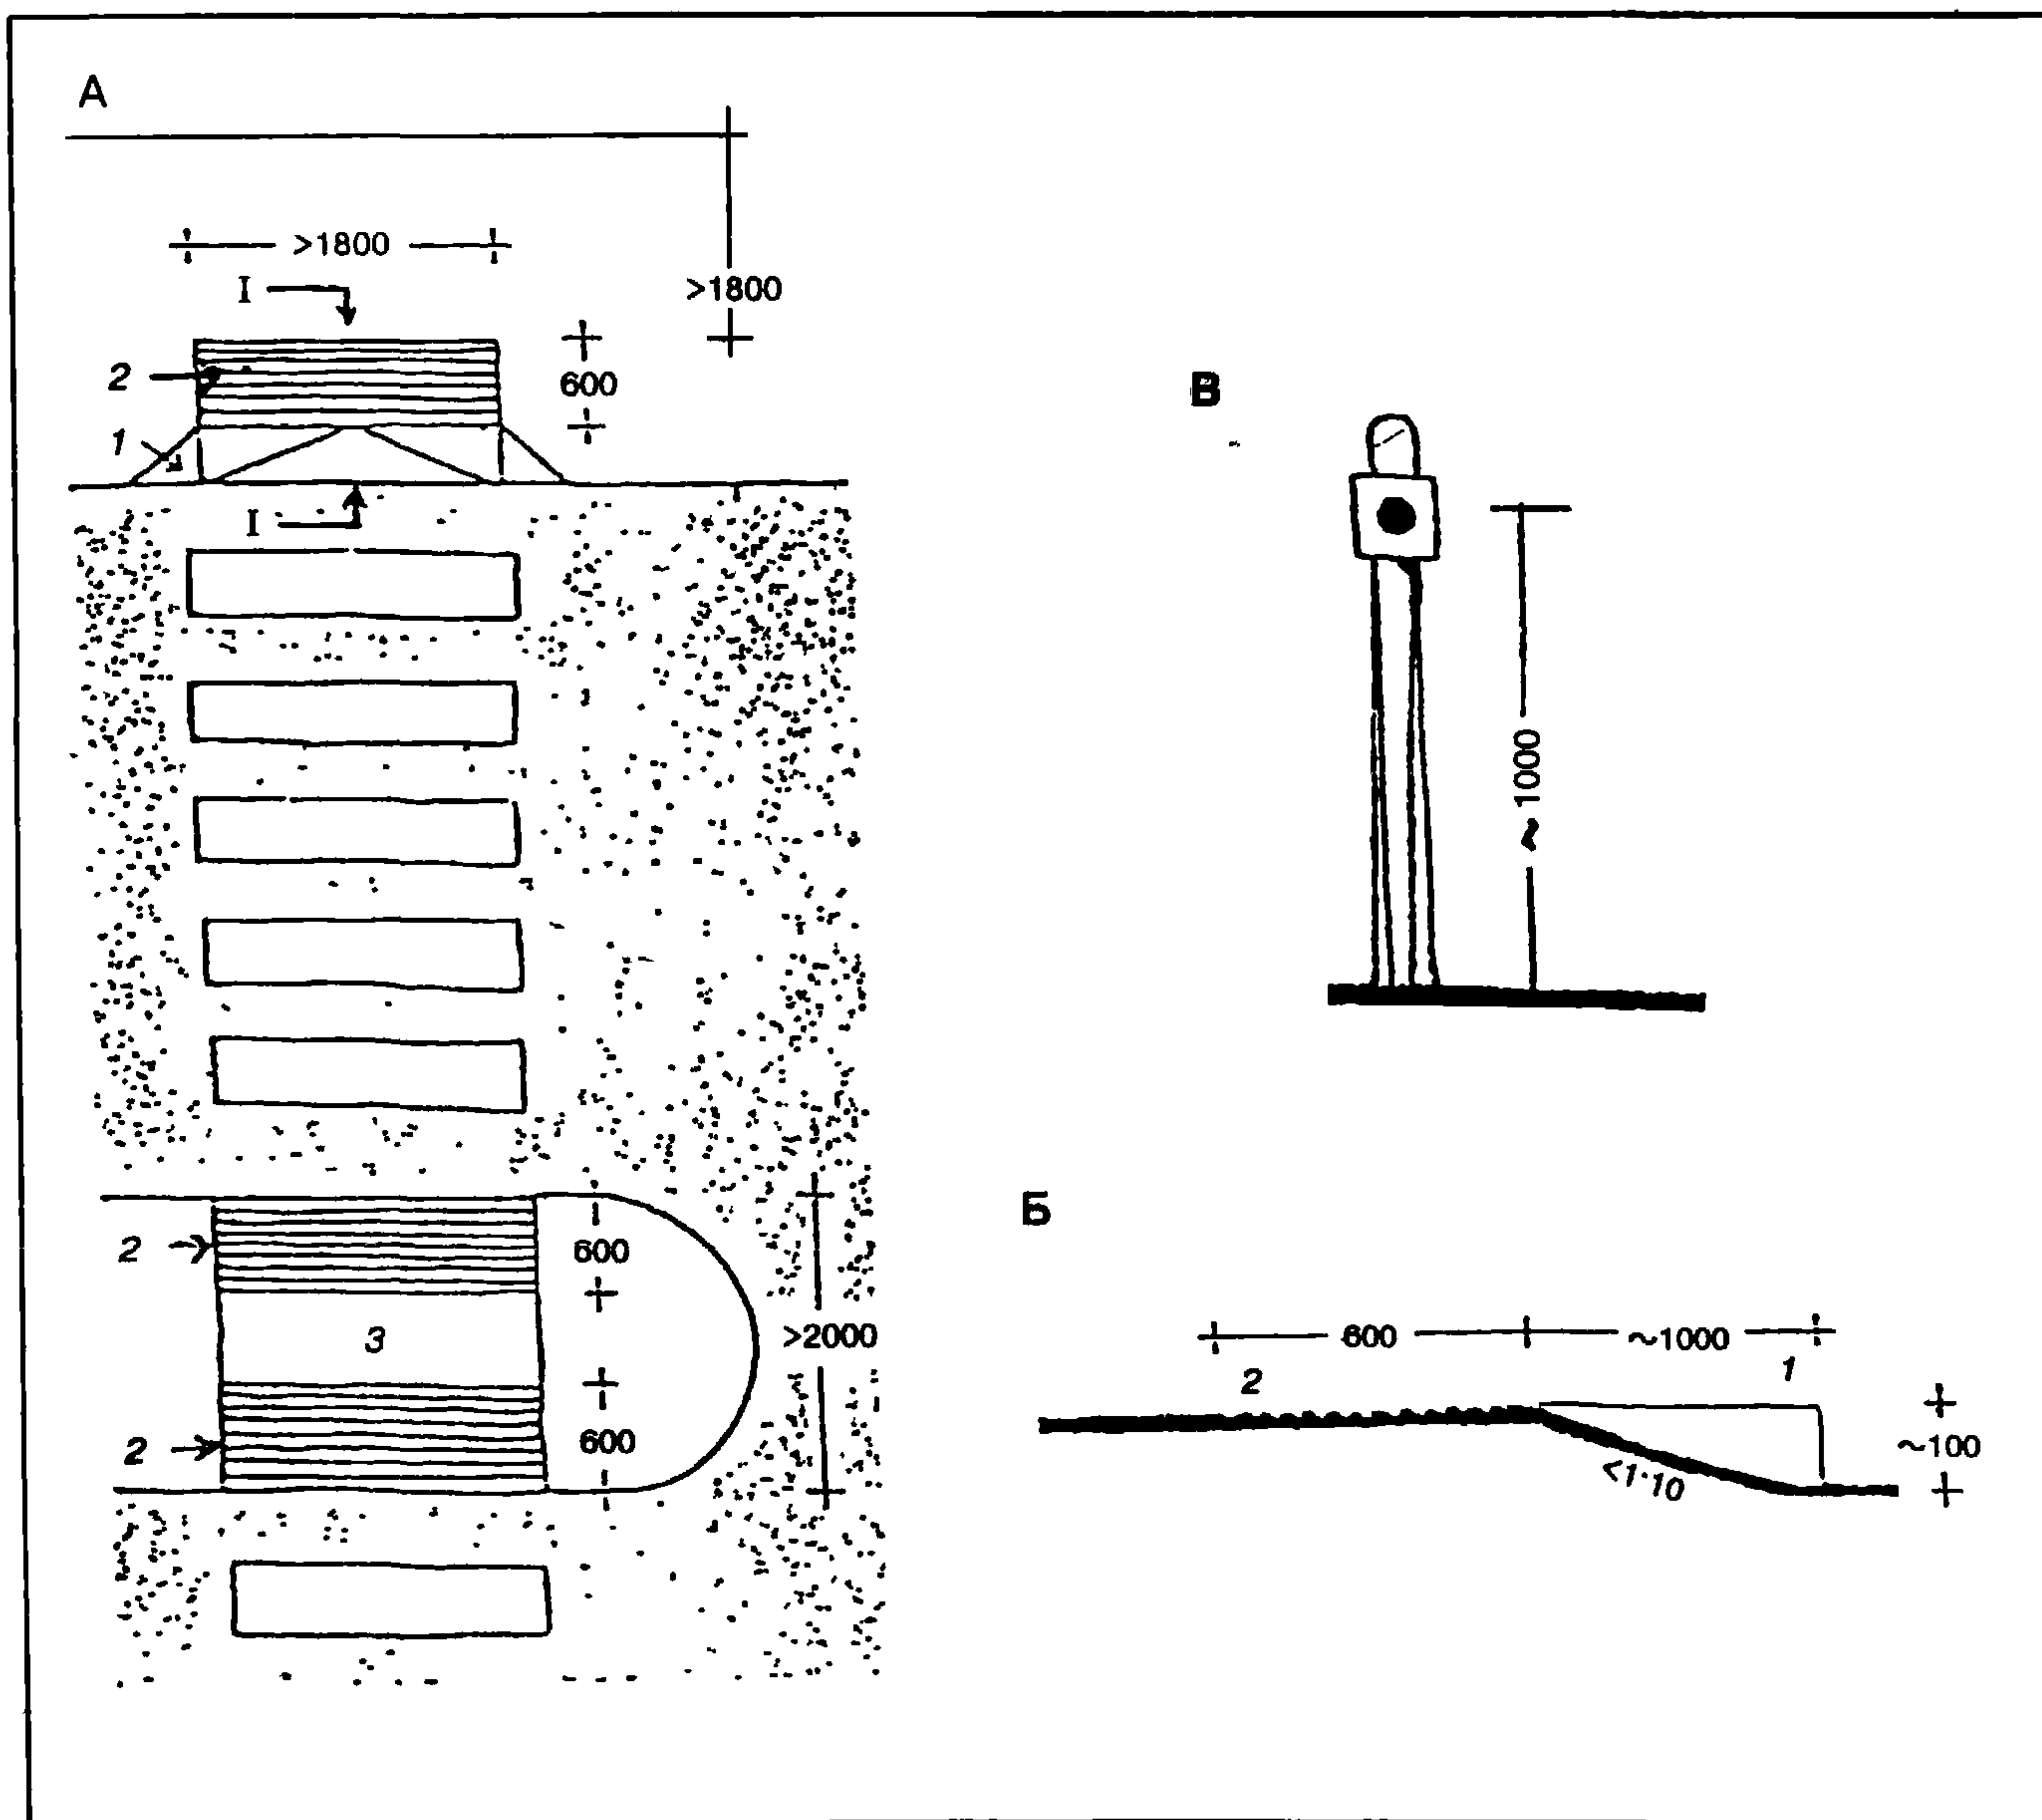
Наземный переход, оборудованный для использования инвалидами
